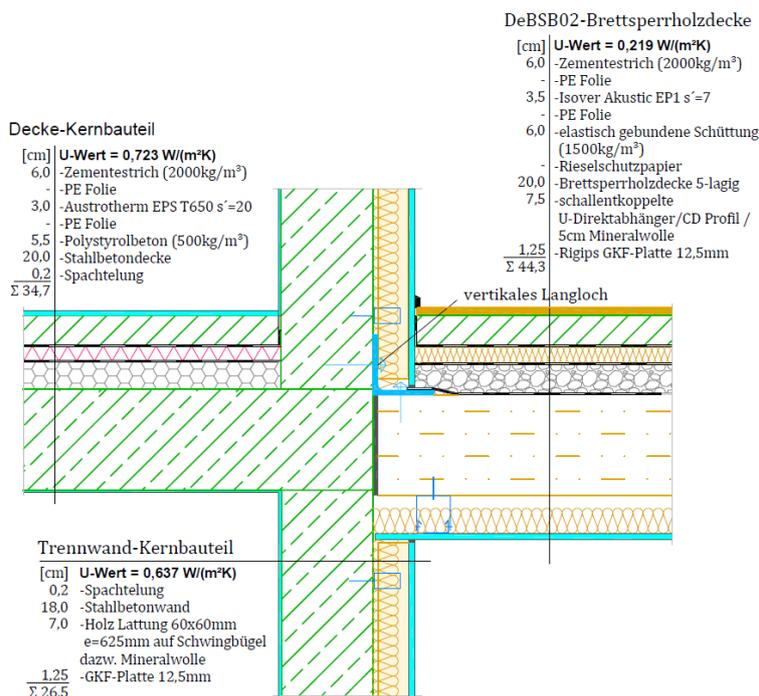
Anschluss der Brettsperrholzdecke an Kernbauteil (vertikal verschieblich)
